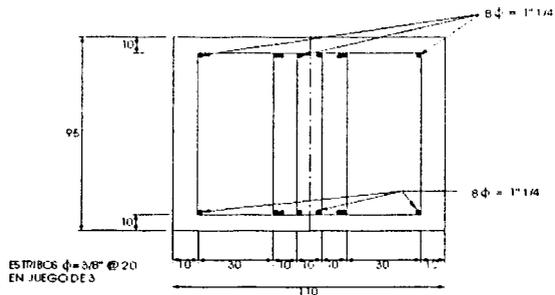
Croquis del Armado Propuesto del Eje Longitudinal D
